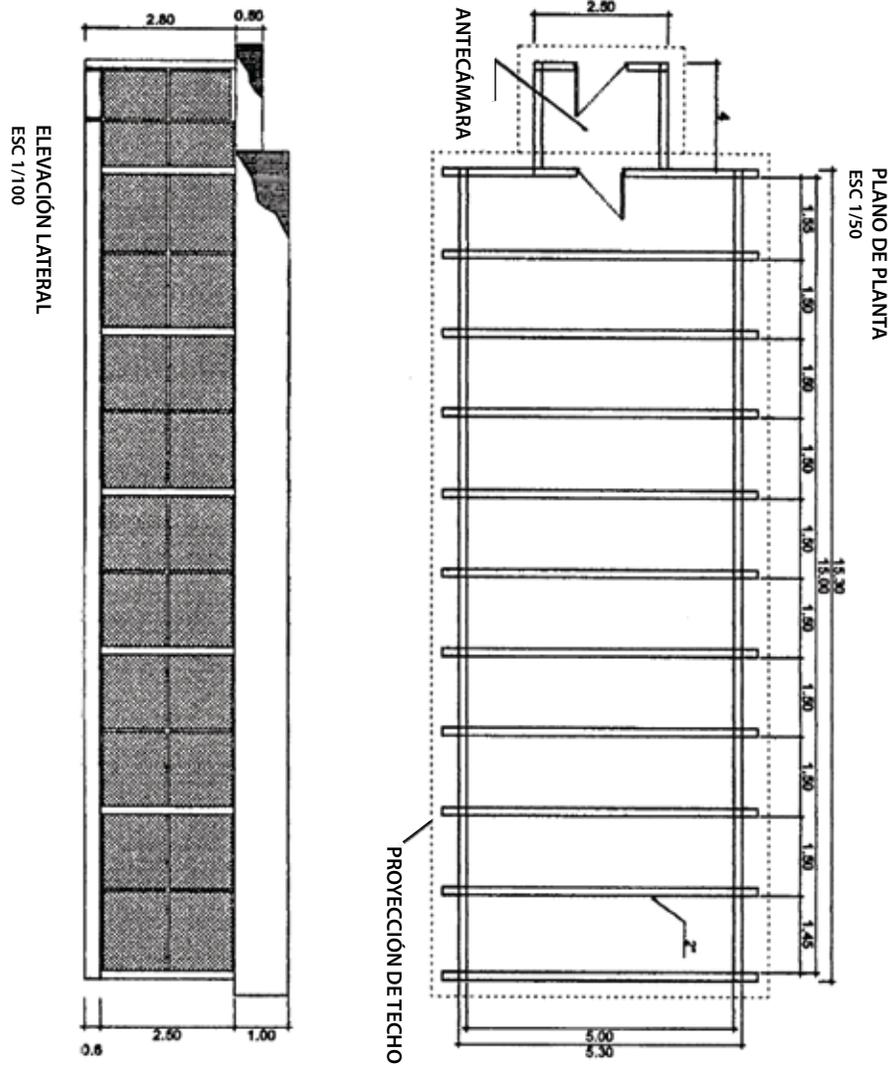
Elevación lateral y plano frontal de un invernadero de 15 x 5 m. incluyendo su antecámara.
